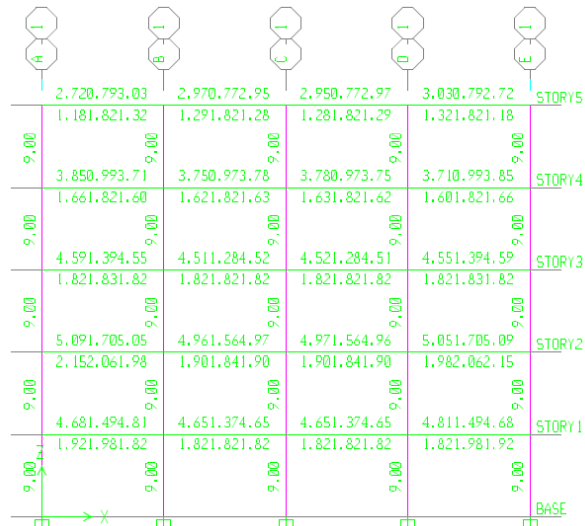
Área de acero en cm<sup>2</sup> para vigas y columnas P5 Caso3, Fuente ; El Autor
